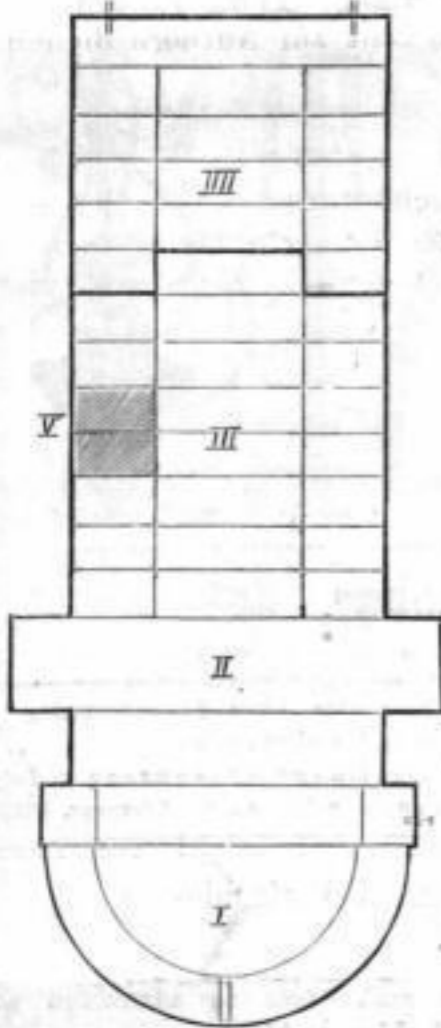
Grundriss des Gebäudes für Chemie, wissenschaftliche Instrumente und Photographien.
